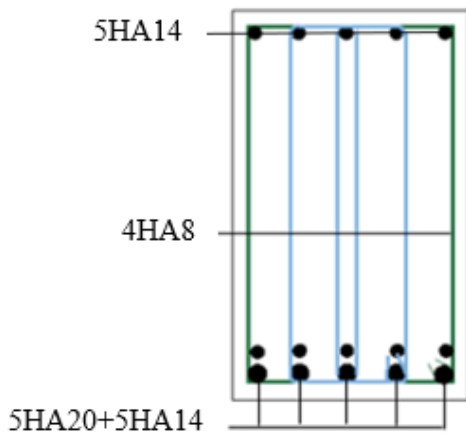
Coupe de ferrailage des poutres principales au niveau de travée
